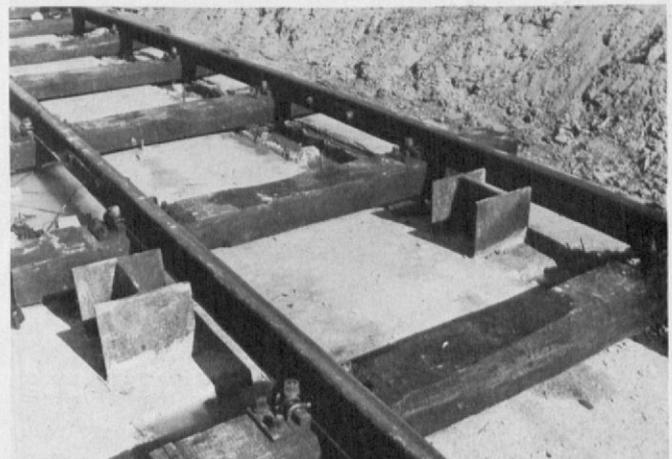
In den Betonunterbau einbetonierte Peiner Träger
